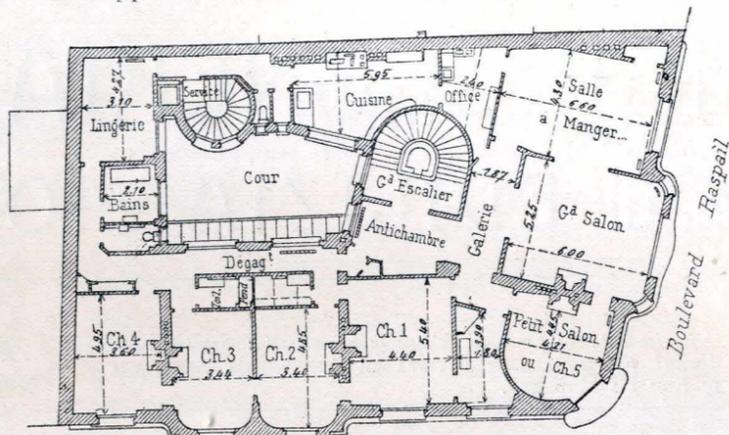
Pianta dell'edificio del Boulevard Raspail.
